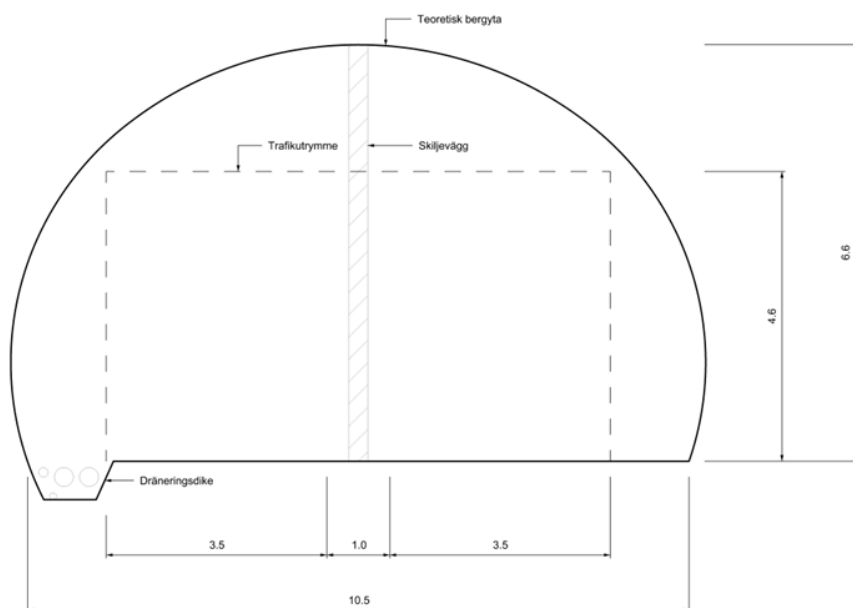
Tunnelprofil, klass B. Tunnelbredd 9,5 m. Källa: Håndbok 021, Statens vegvesen.
